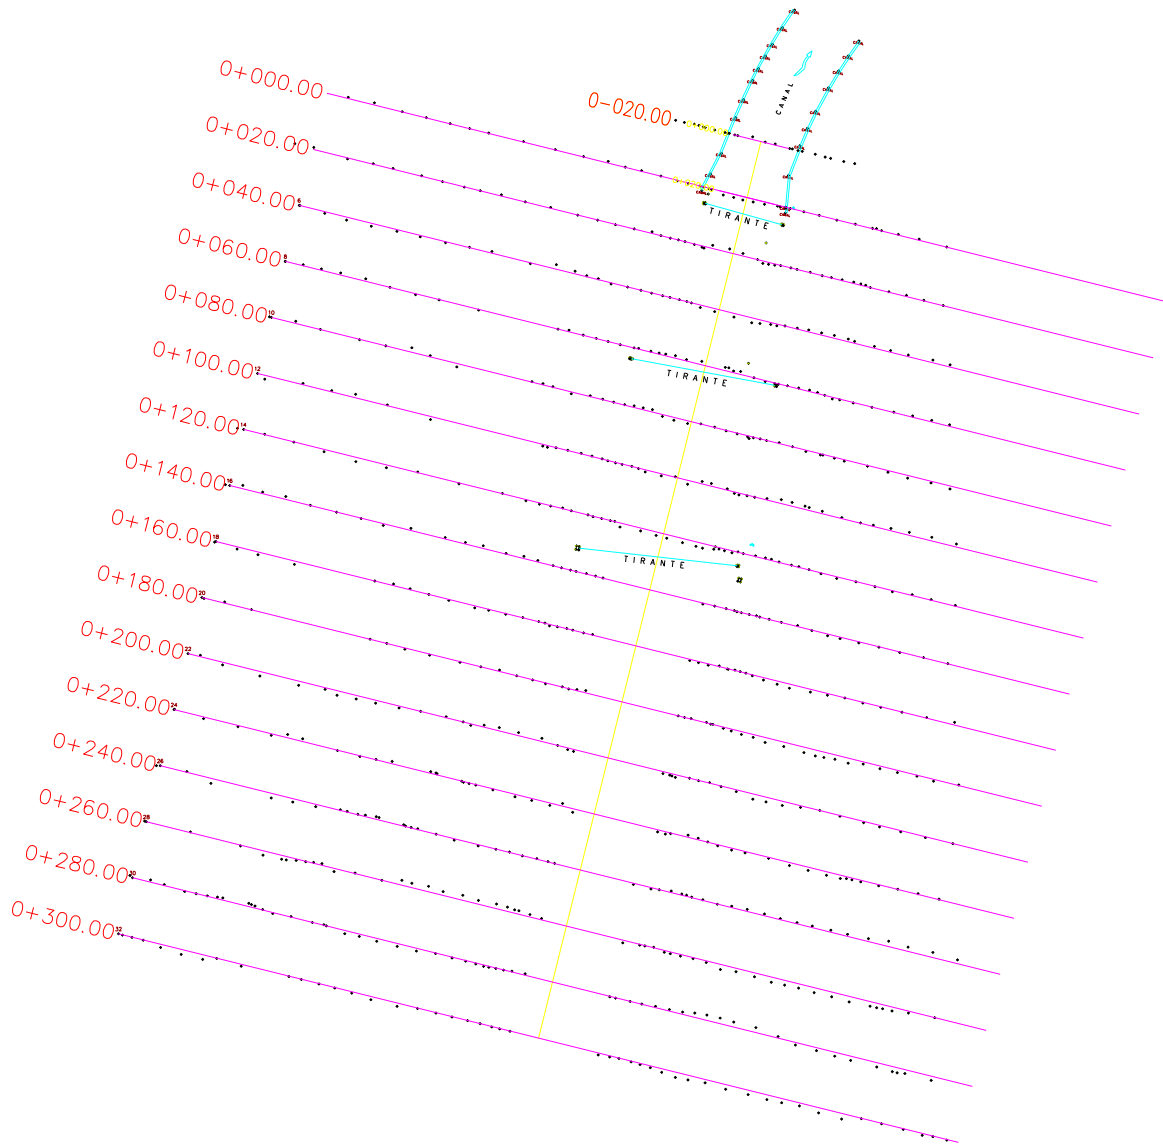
Levantamiento en planta de 300 m x 300 m de la salida del Dique Mariquita a cada 20 m.
